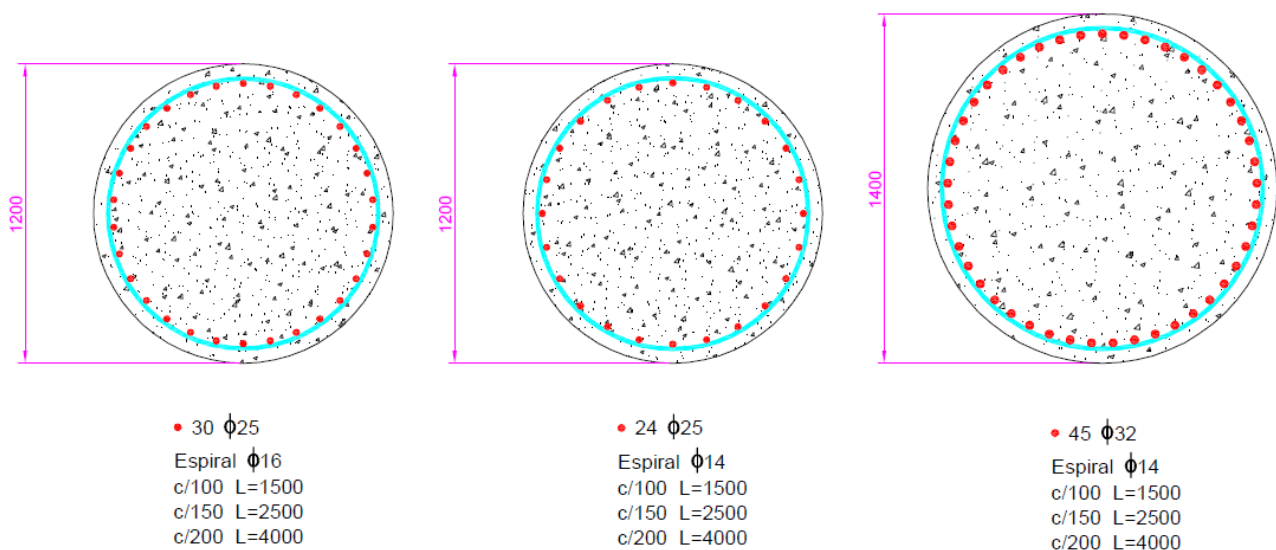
Diseño de columnas en ejemplos 3.1, 3.2 y 3.3
